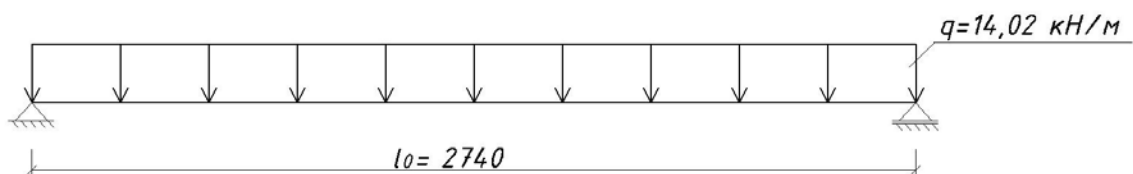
Спрощена розрахункова схема лобової балки сходового маршу
